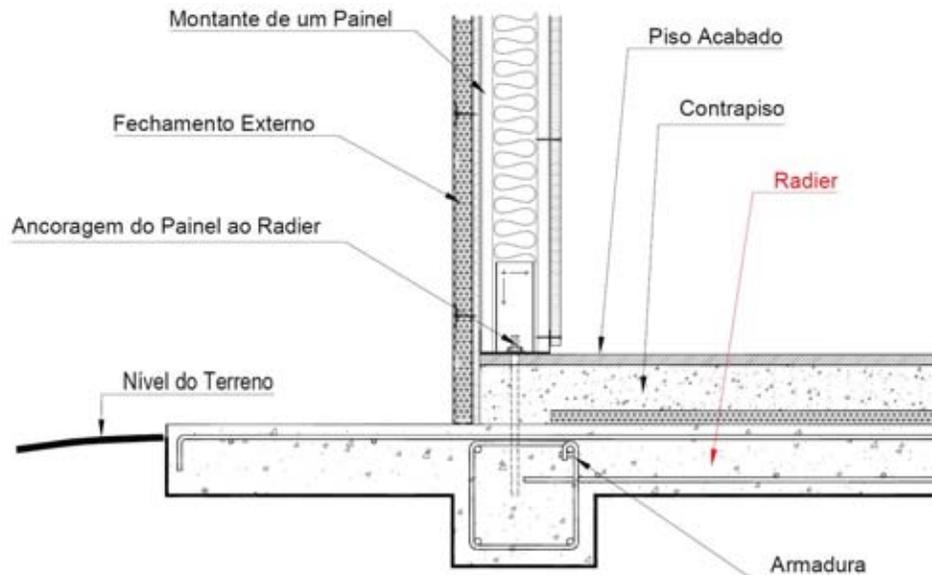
Esquema de ancoragem de painel do sistema LSF em fundação do tipo radier (Adaptado de CONSULSTEEL, 2010).
